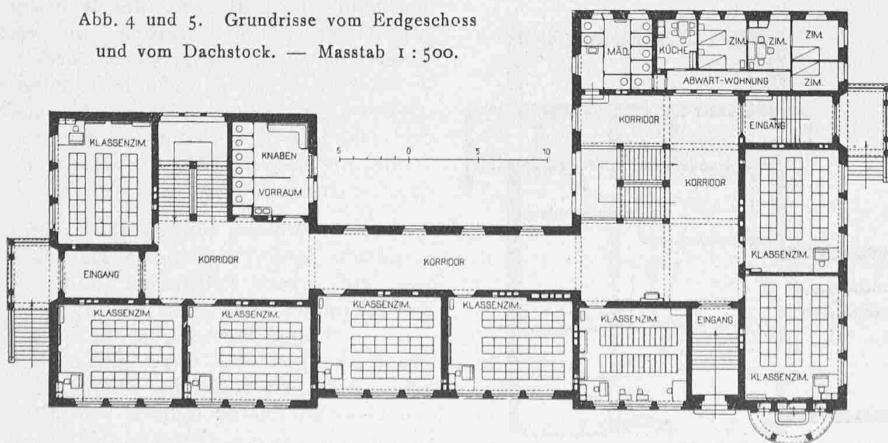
und 5. Grundrisse vom Erdgeschoss und vom Dachstock. — Masstab 1 : 500.
